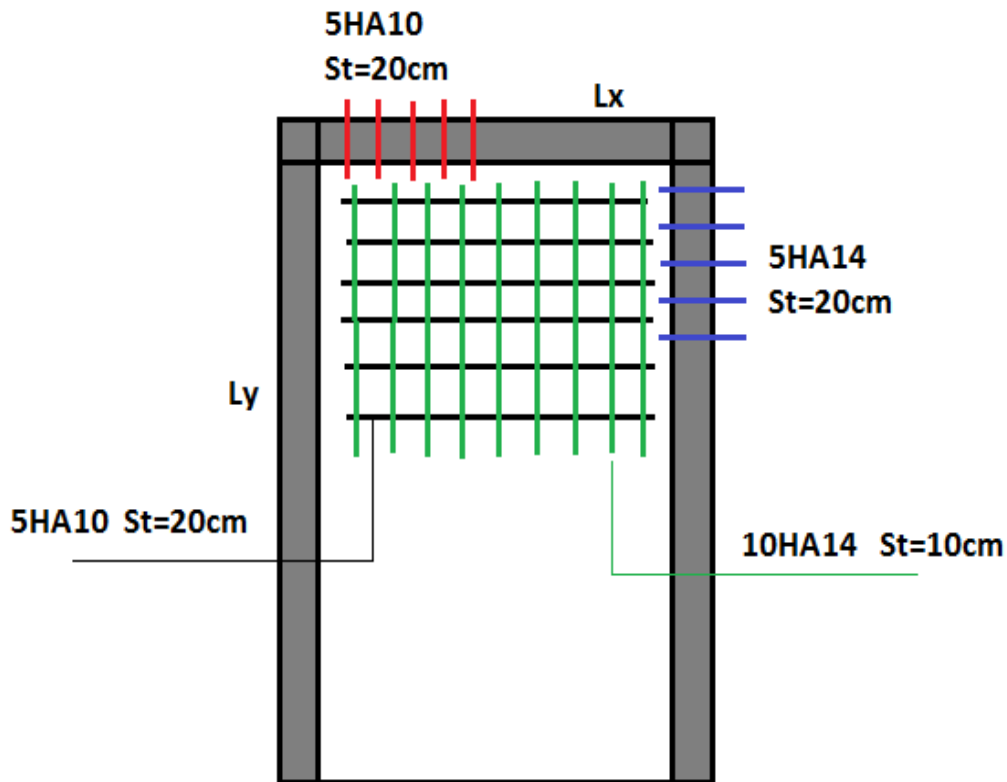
Schéma de ferrailage Dalle pleine sur appuis trois D1
